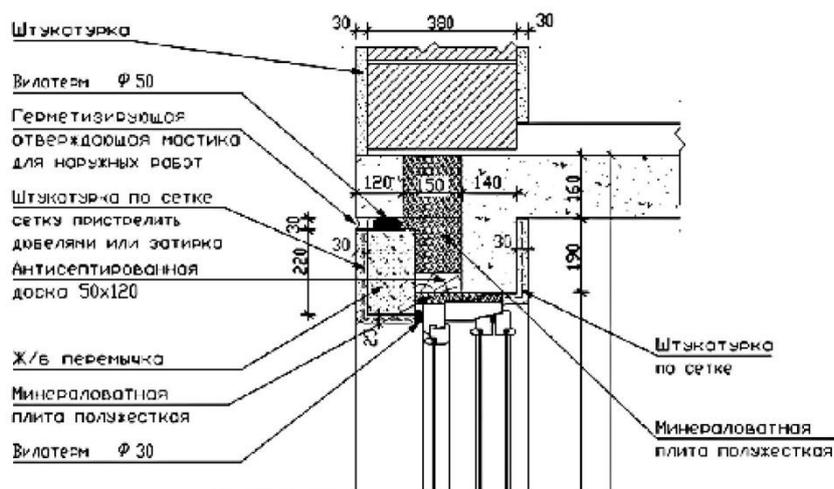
Узел решения ограждения из крупноформатных керамических камней, для зданий до 17 этажей (50 м)
